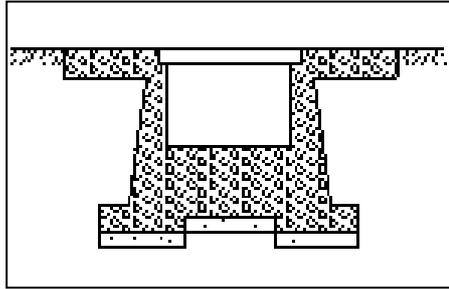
Drainase Segi Empat Beton Bertulang.
